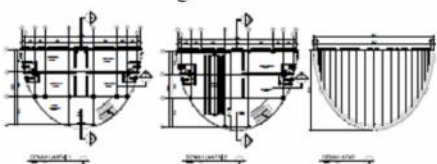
Tampak dan Potongan Gedung Pendidikan
